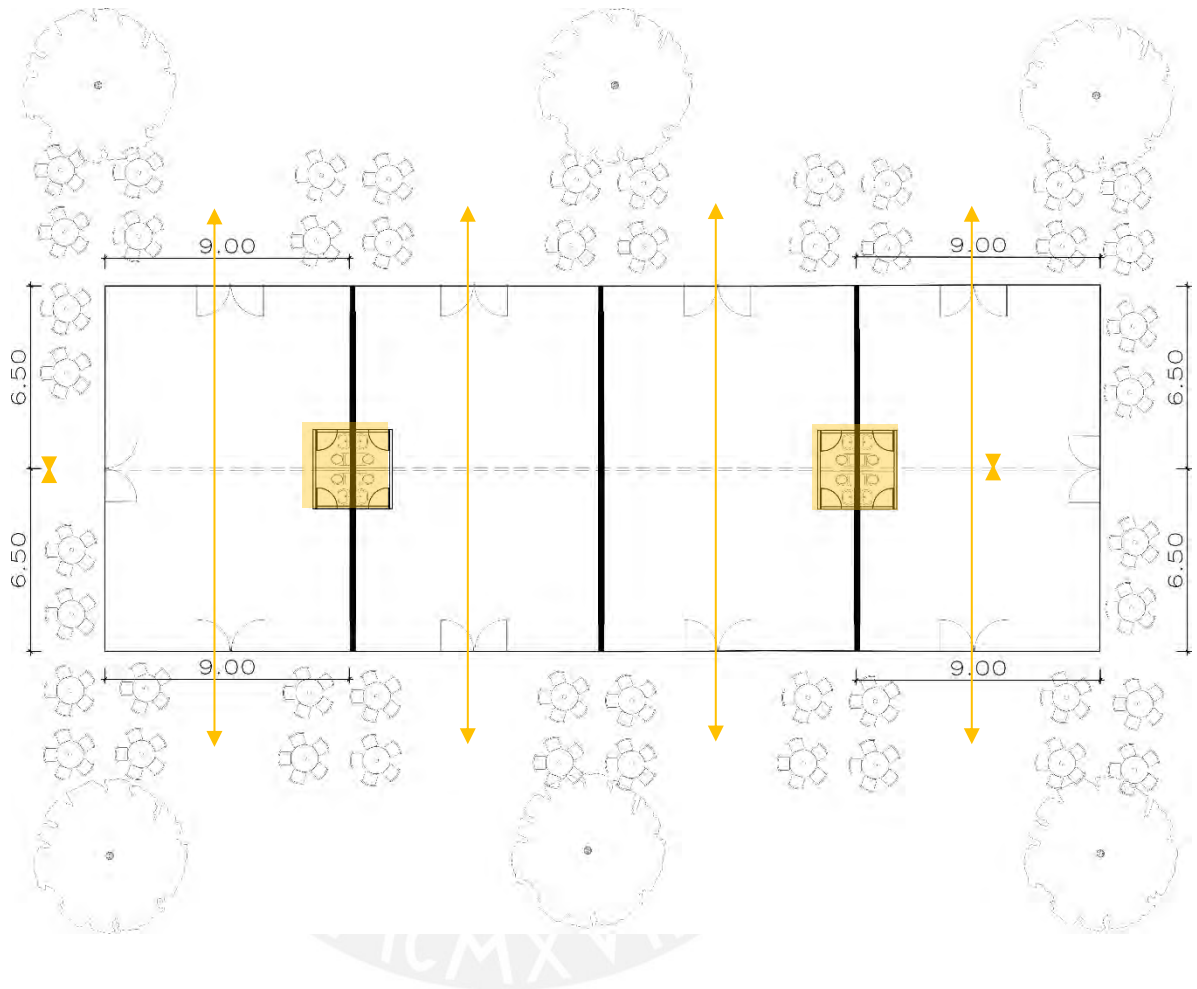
Planta típica de tiendas flexibles en el primer nivel de comercio. Elaboración propia
